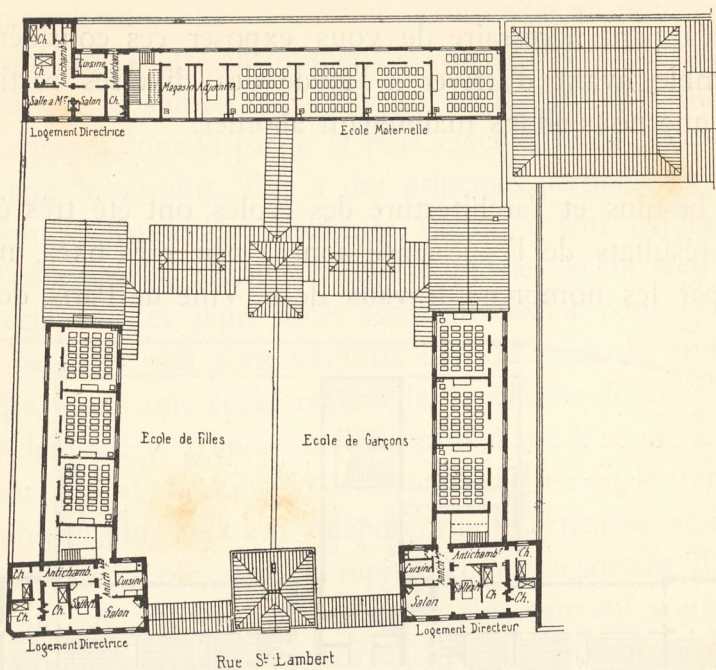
Groupe scolaire, à Paris (M. Bouvard, architecte). Plan du 1^{er} étage.
